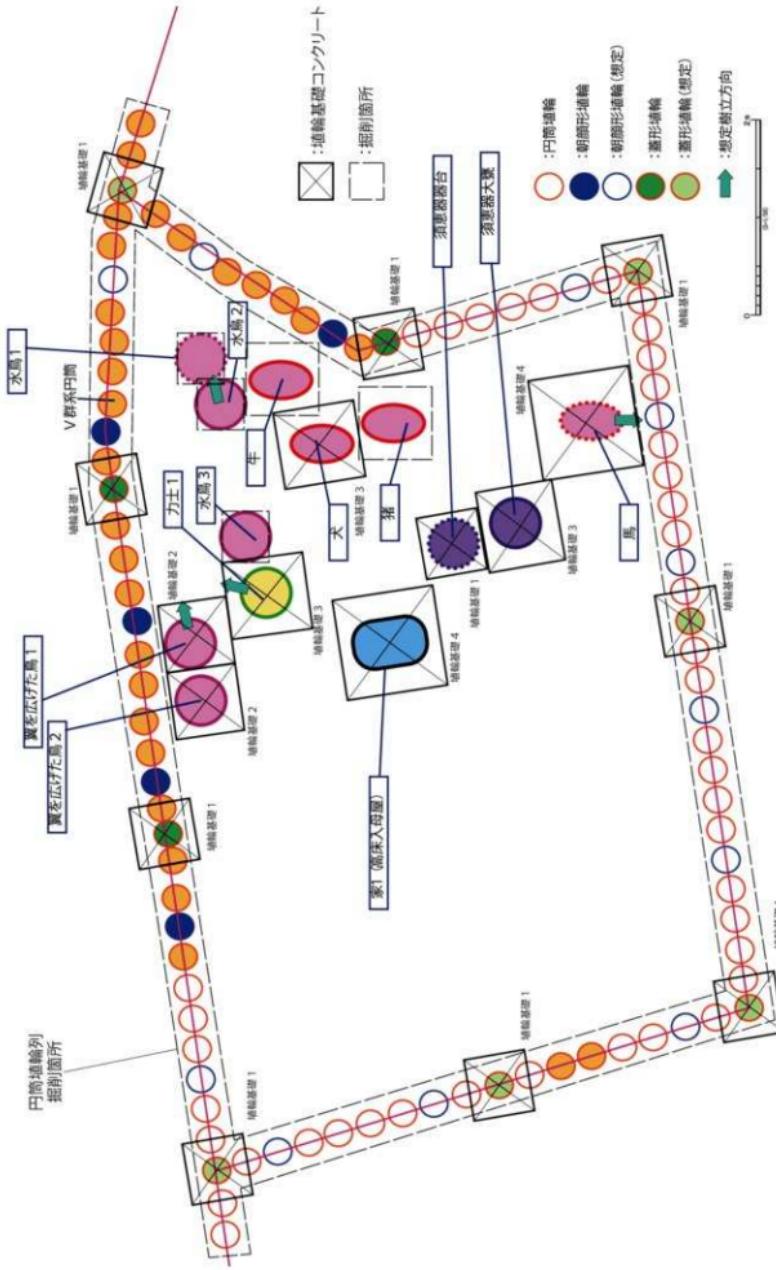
大日山 35号墳 東造出 復元埴輪設置基礎配置図
